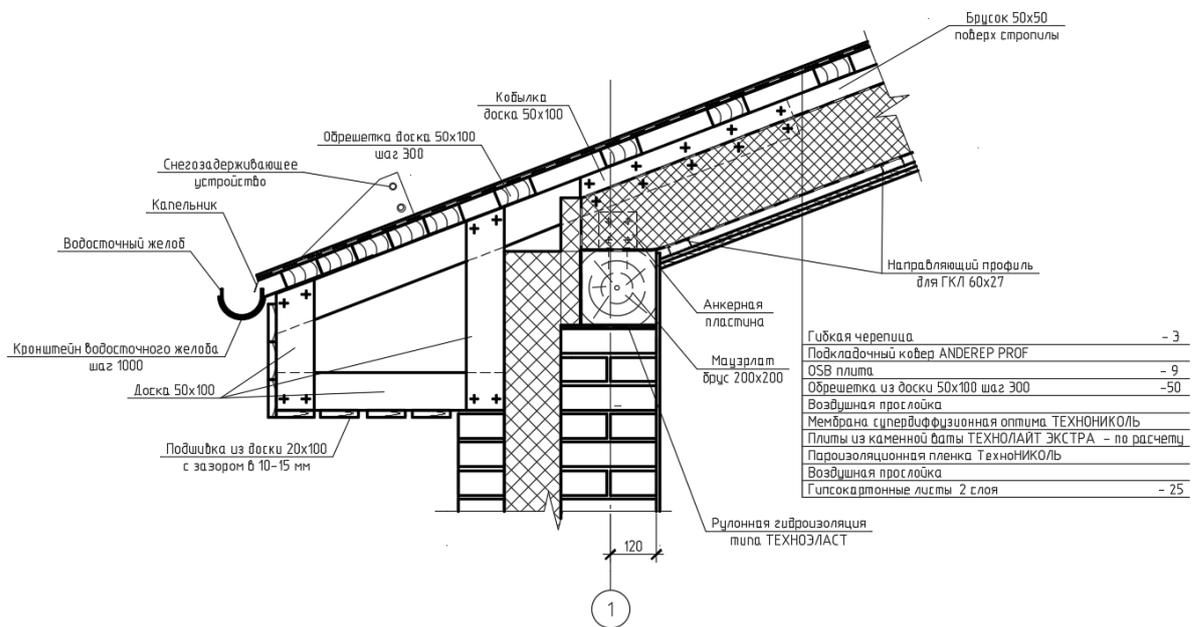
Пример выполнения карнизного узла утепленной кровли мансарды
